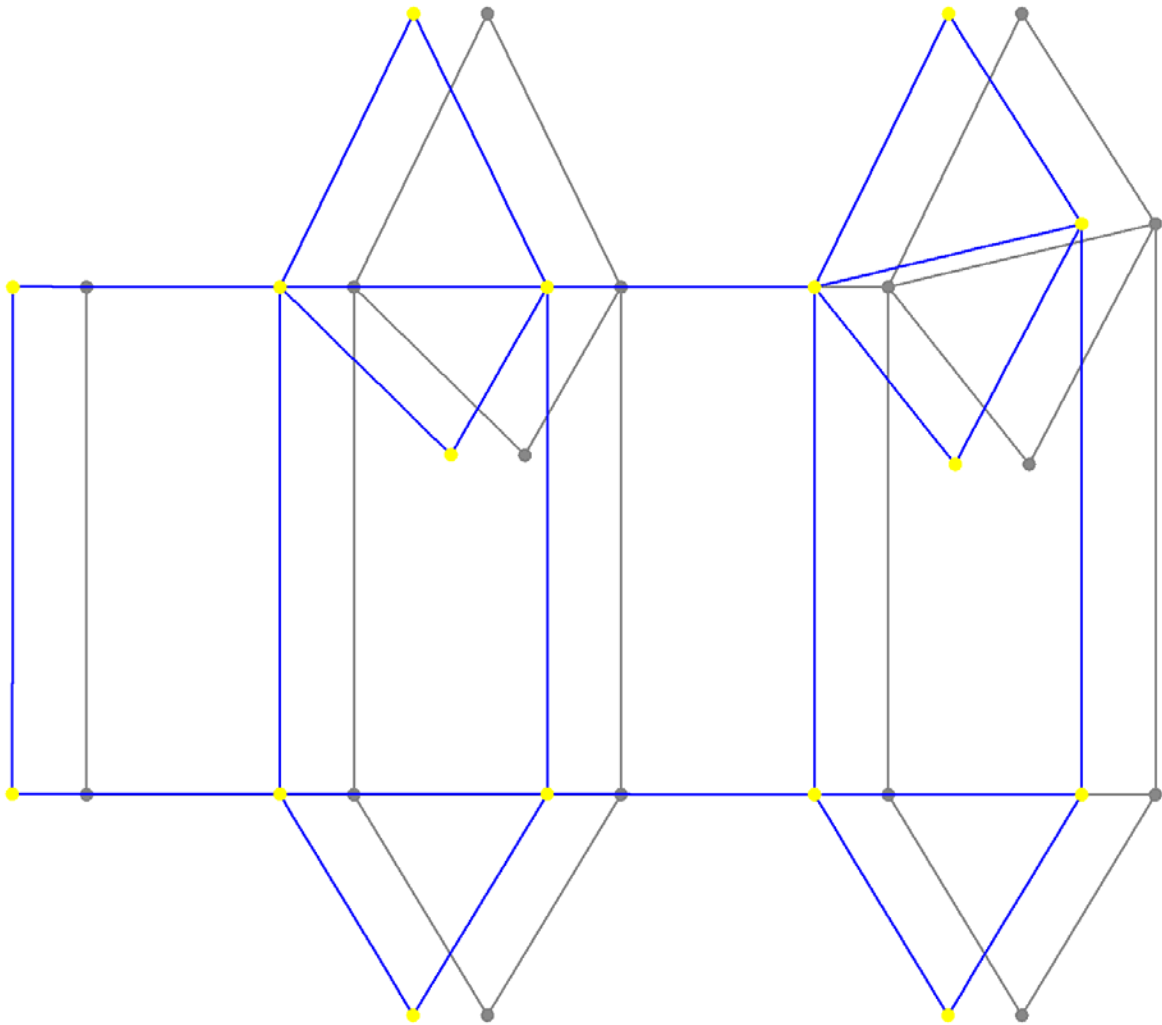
Planta cubierta (N +14.0 m) modelada con Frames en SAP2000
